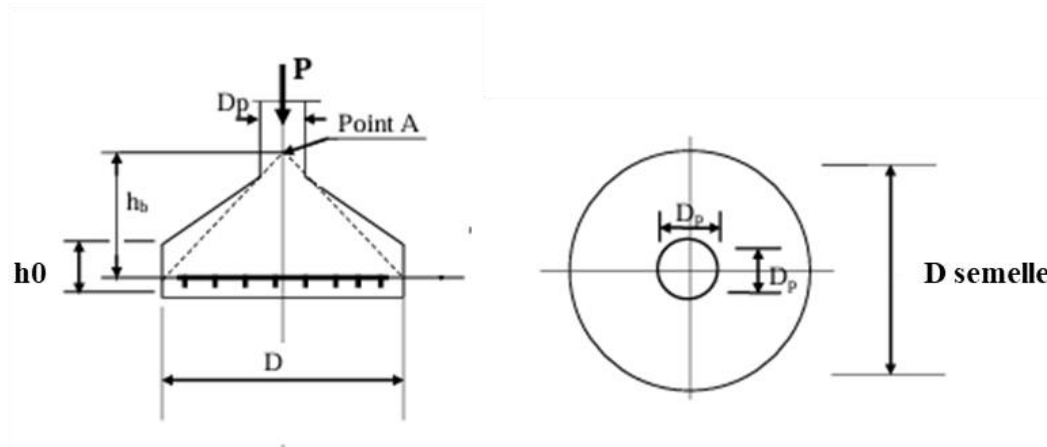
Coupe et vue en plan d'une semelle circulaire, isolée sous poteau.
